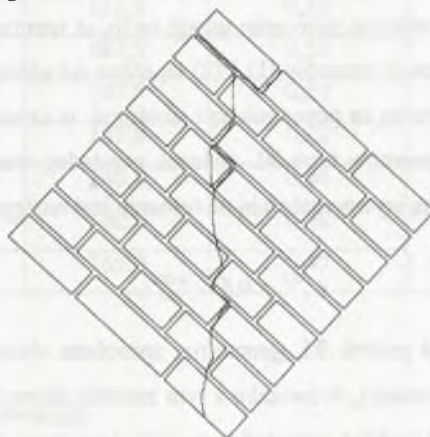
Przykładowe obrazy zarysowania fragmentów muru w zestawie MC-1/3
